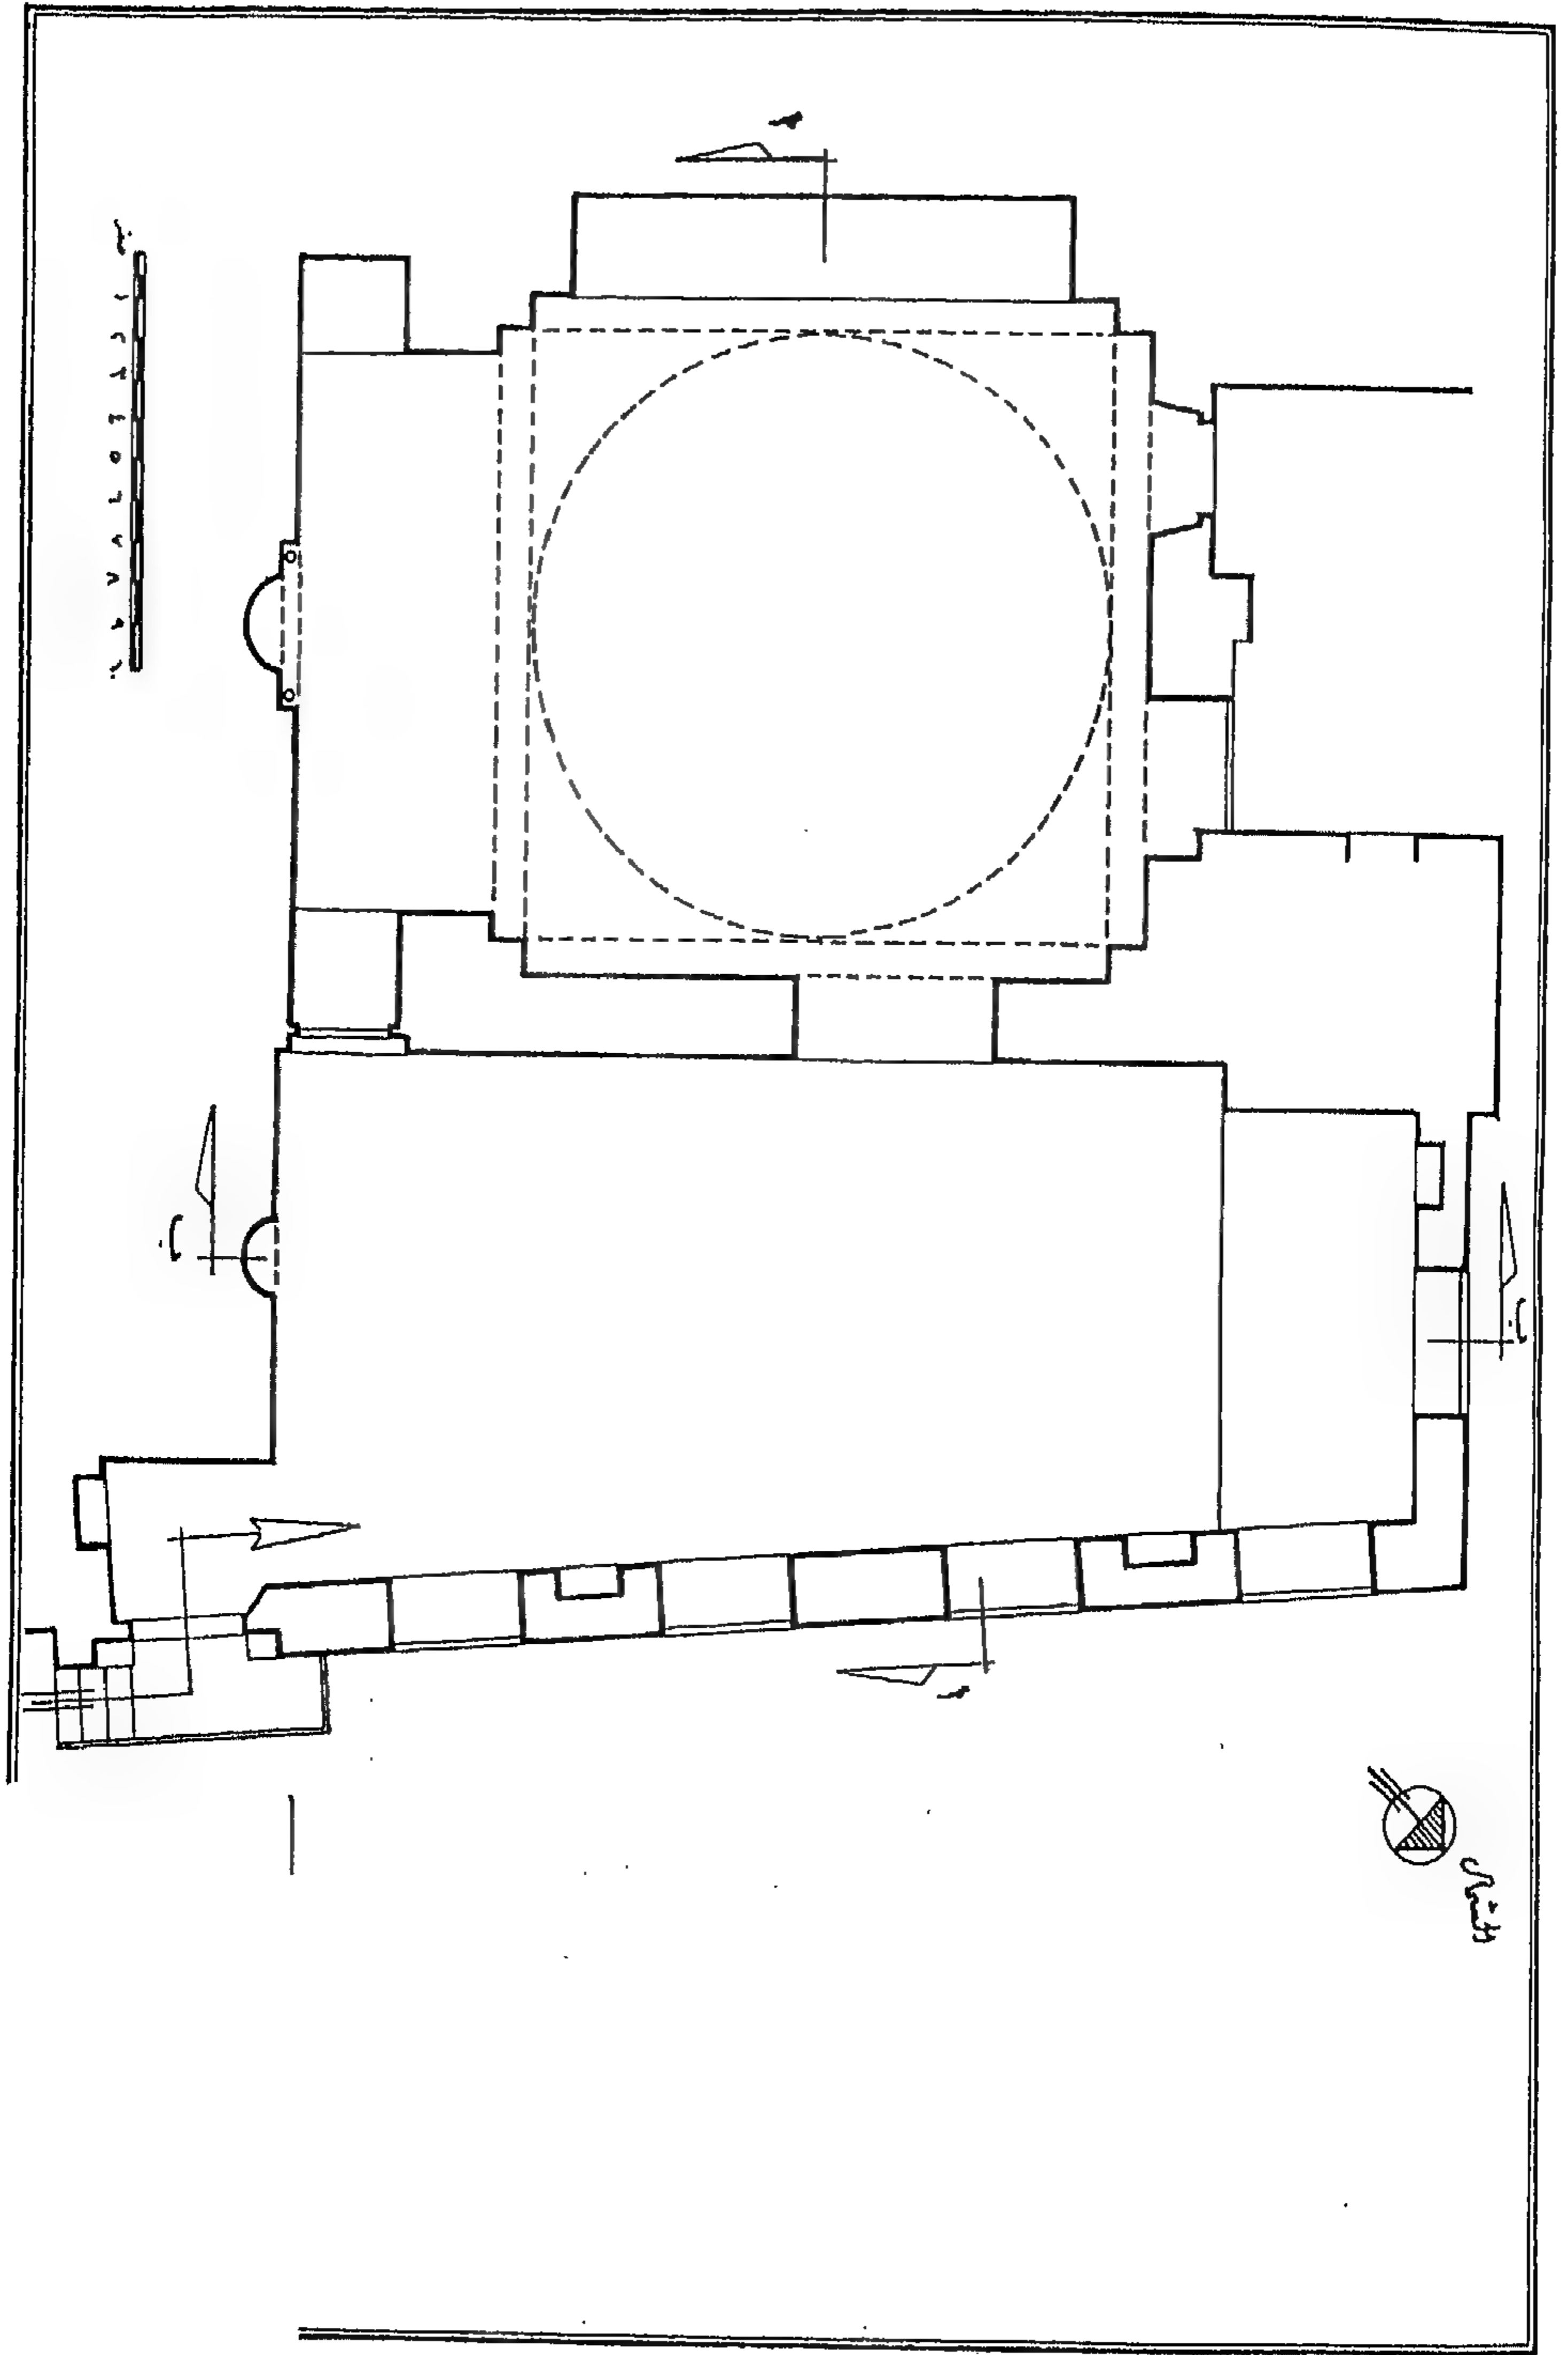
مسقط أفقي لزاوية الدمرداش بالعباسية (عن : درويس أبو سيف) .
